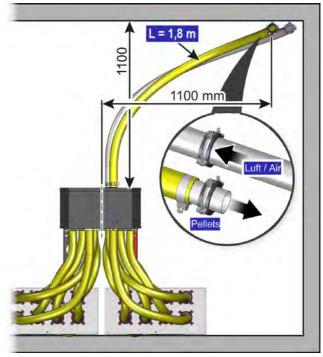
Befestigung der Pelletsschläuche (Frontalansicht)
